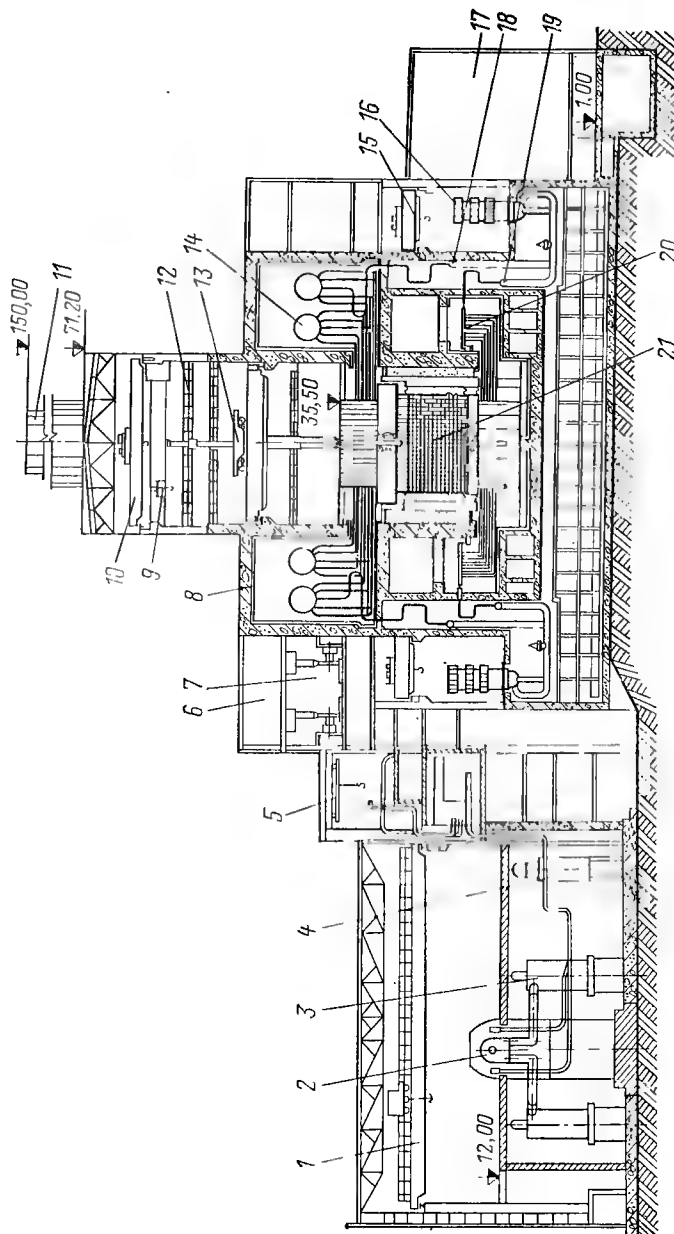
Поперечный разрез главного корпуса АЭС с реакторами РБМК.
